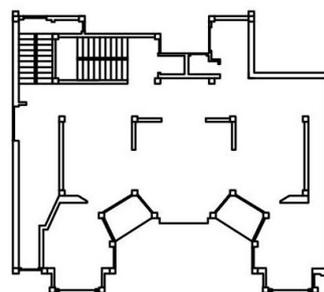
Pianta Tipo casa Rue Franklin, Auguste Perret
